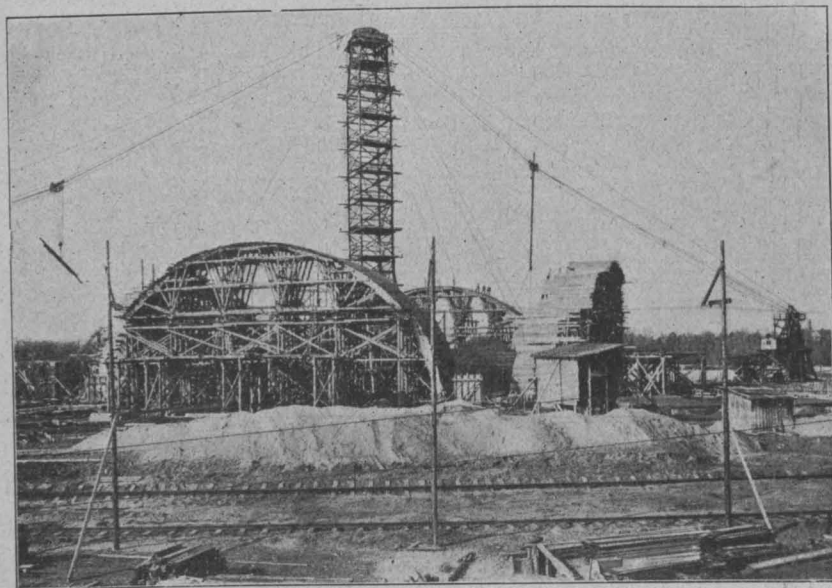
und 11. Karussell-Kabelkran beim Bau der Jahrhunderthalle zu Breslau bei Ausführung der Rüstungs- und Eisenbeton-Arbeiten. Kabelkrane bei der Ausführung von Hochbauten.
